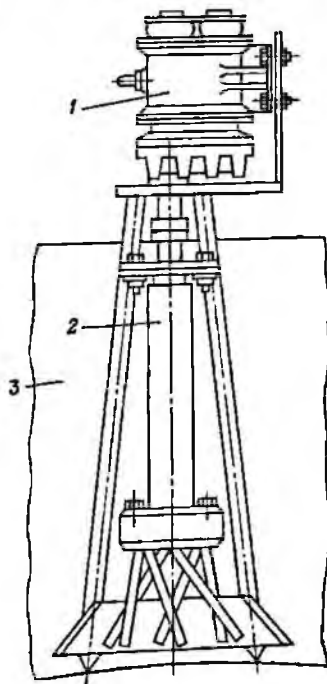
Смеситель-активатор растворной смеси бадьевого типа конструкции ВНИИОМШСа:
